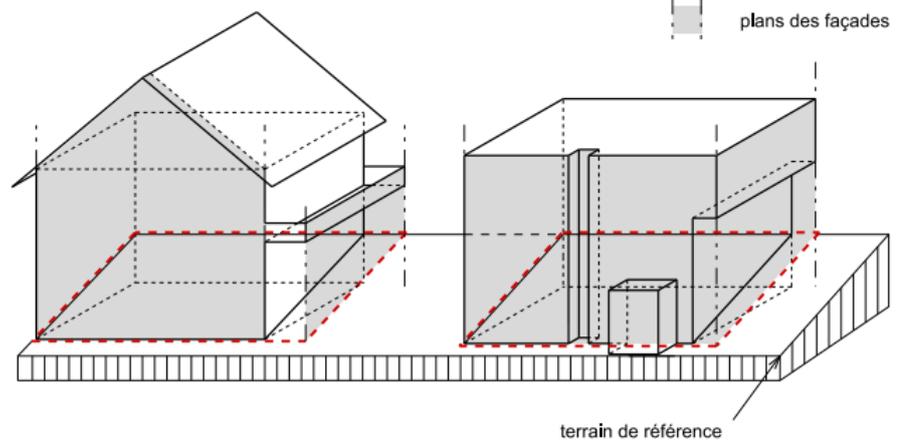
3.3 Plans des façades et projection du pied de façade
